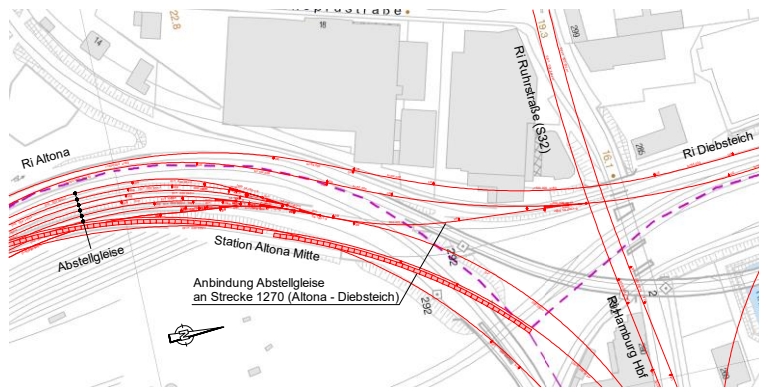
Lageplan Anbindung Abstellgleise an Spange
